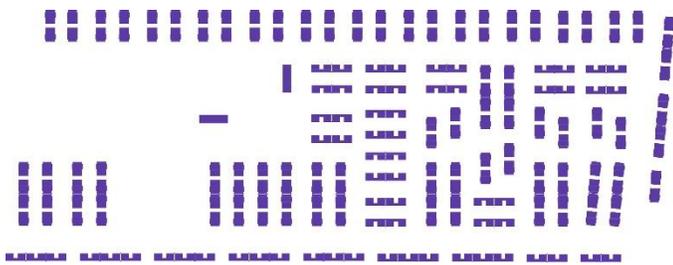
Volúmenes Marta Brunet. Fuente: Elaboración propia.
